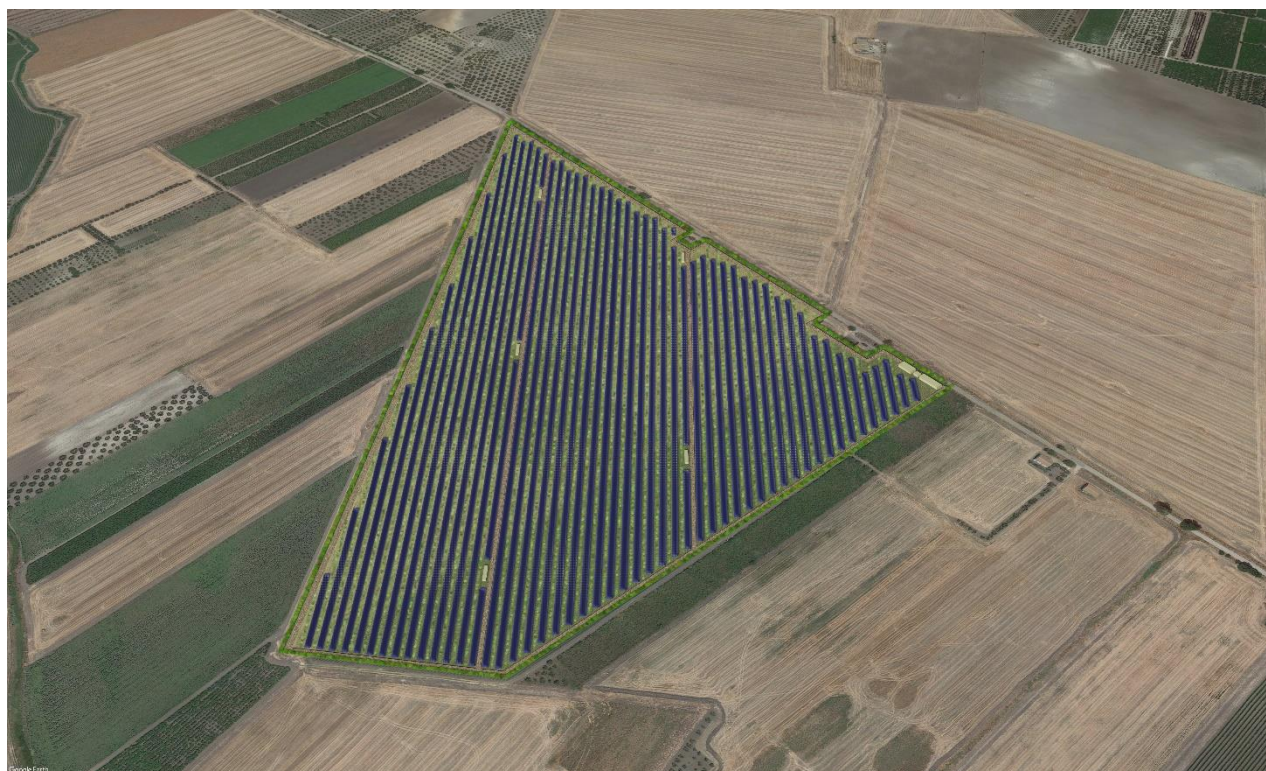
Vista aerea – Fotoinserimento dell'intervento in progetto
